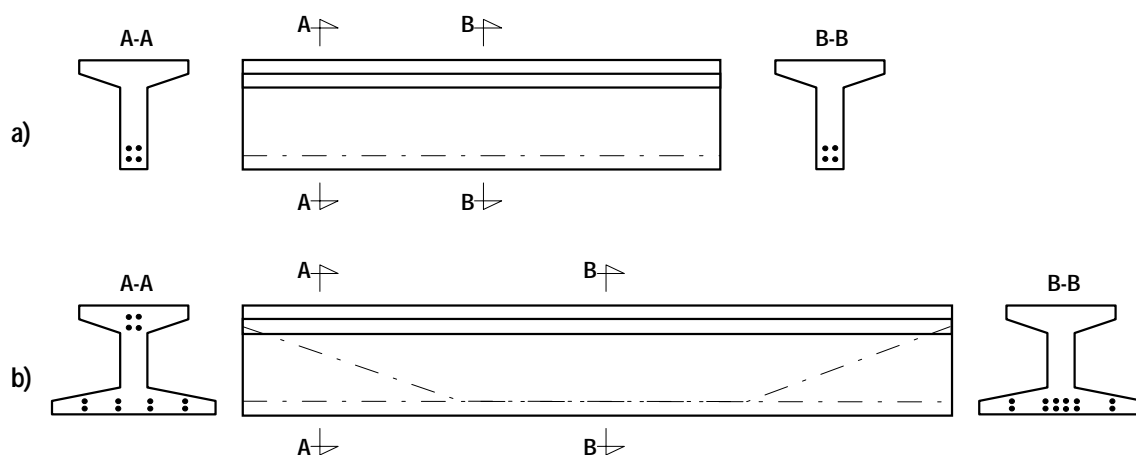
Exemplos de distribuição de armadura pré-tracionada em vigas: a) viga de pequeno porte com cabos retilíneos; b) viga de grande porte, tendo parte da armadura com traçado poligonal.
